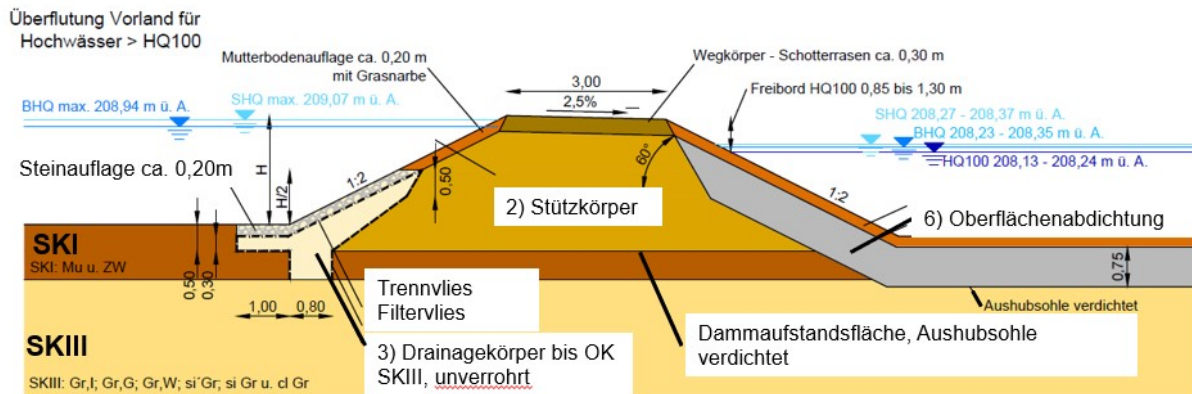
Detaillierter Dammaufbau im Bereich der Einlaufmulde, beispielhaft für RQ16b (Zulaufmulde links) aus [17]
